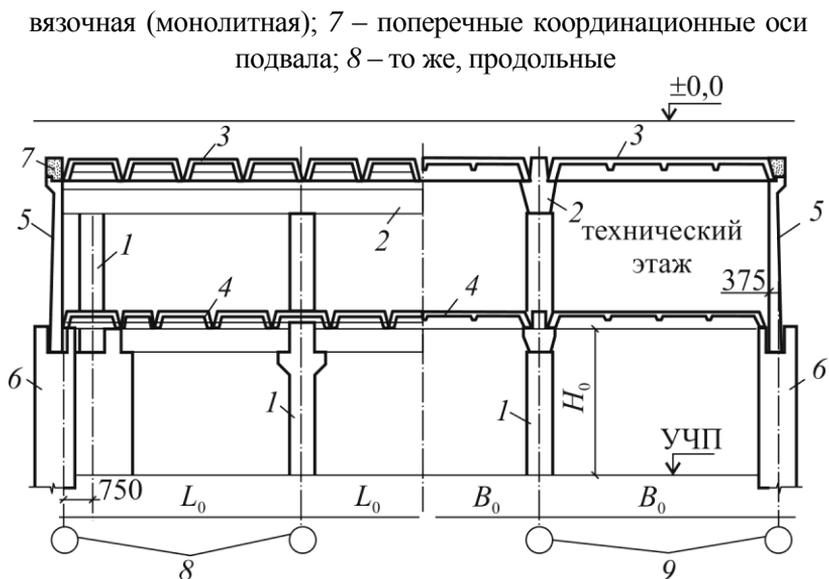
Пример конструктивного решения подвального помещения с техническим этажом: 1 – колонна; 2 – ригель; 3 – панель перекрытия; 4 – панель междуэтажного перекрытия; 5 – панель стенная; 6 – фундаментная стена (монолитная); 7 – балка обвязочная (монолитная); 8 – поперечные координационные оси подвала; 9 – то же, продольные
